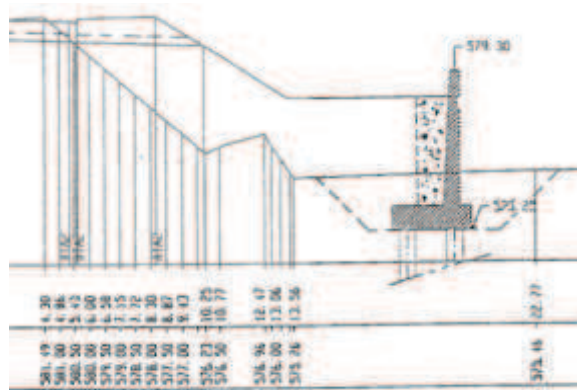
Plan de recollement du mur béton à l'amont immédiat de la culée rive droite.
